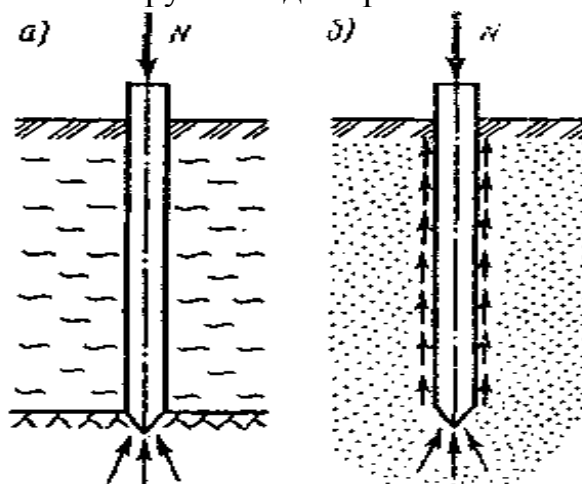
Схемы передачи нагрузки сваями на грунты основания
